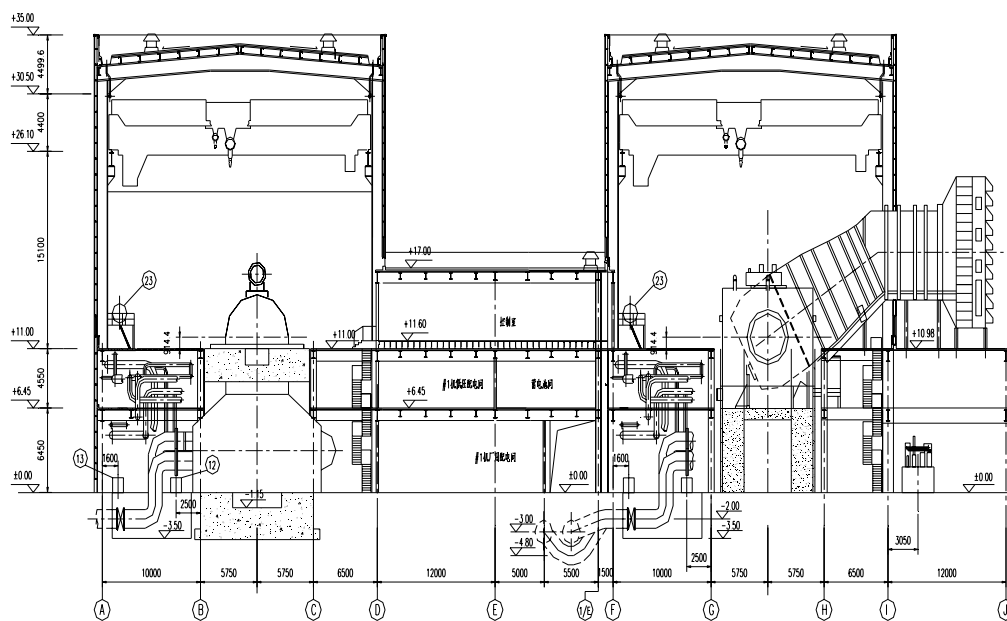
望亭电厂 2 套 F 级燃气—蒸汽联合循环机组 (GE STAG109FA-SS) 平面布置图
